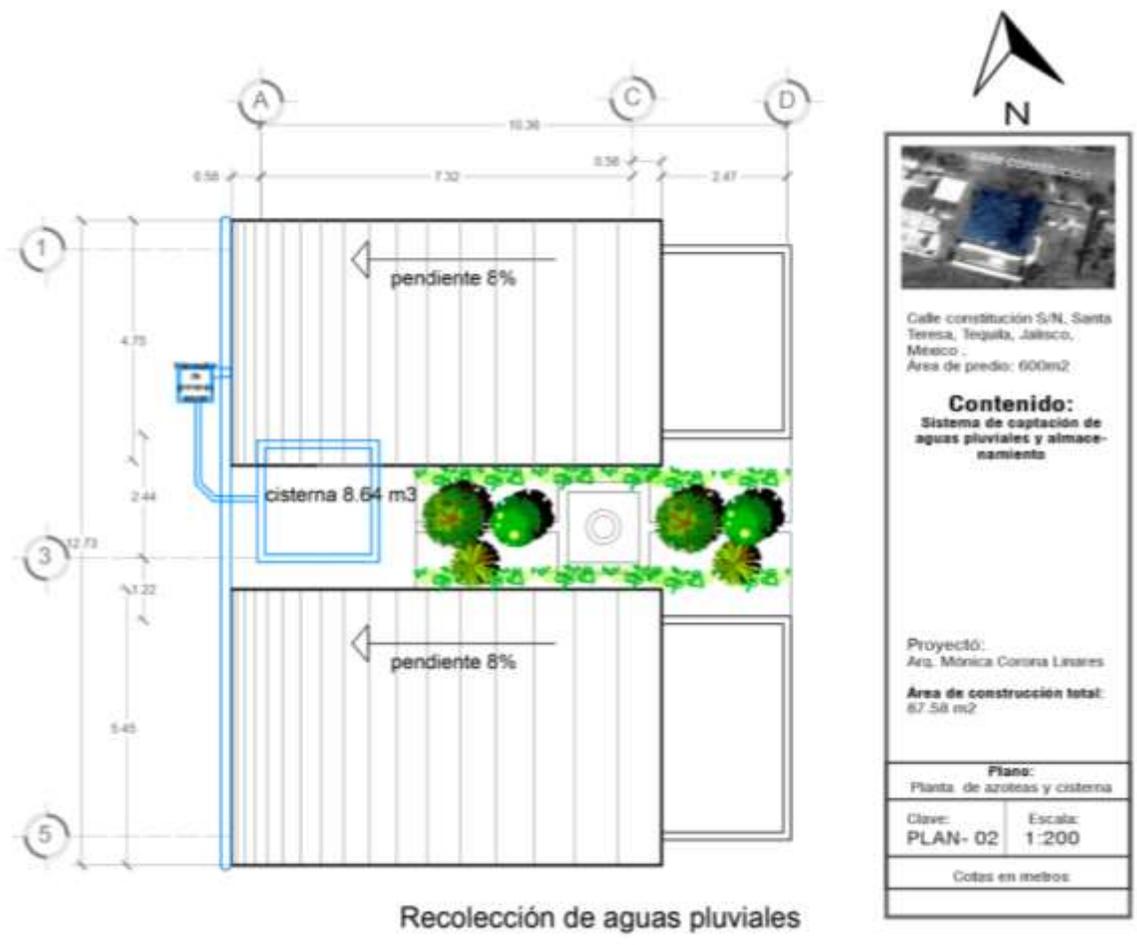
Planta de azotea con instalación de captación de aguas pluviales.
